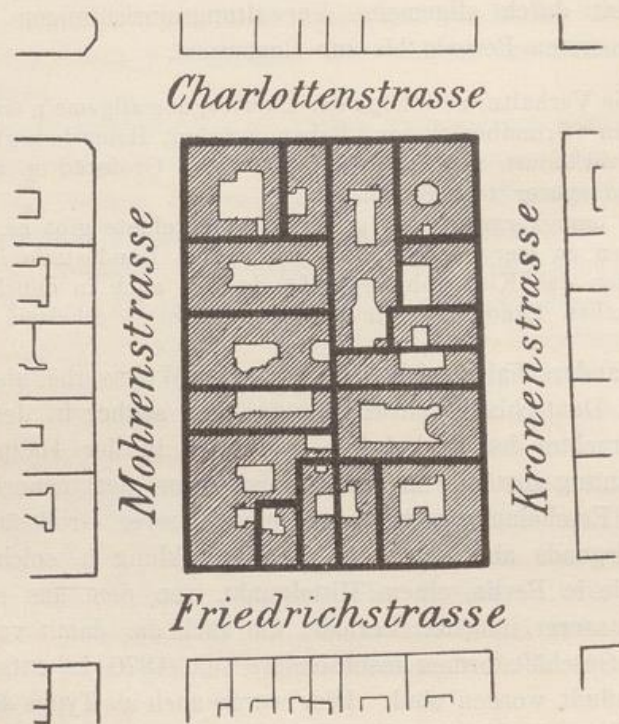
Alter Berliner Baublock der Friedrichstadt (Geschäftsviertel) in der Bebauung von 1902. Maßstab 1:2000.
